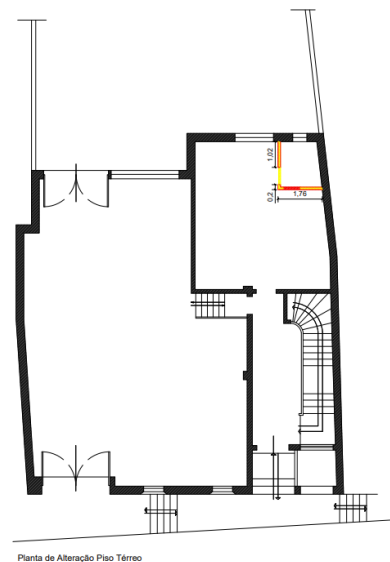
Planta de Alterações, Piso 0, fonte a autora
